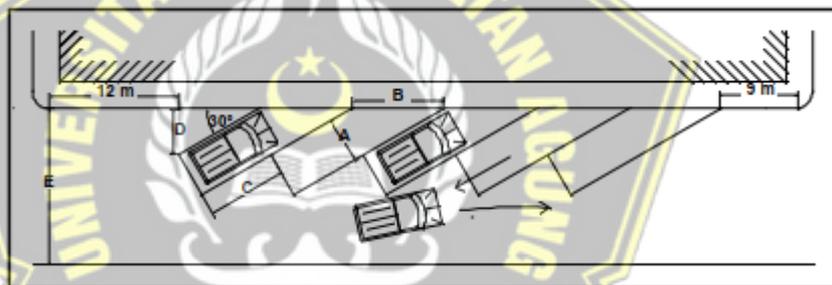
Parkir di badan jalan (*On Street Parking*)
